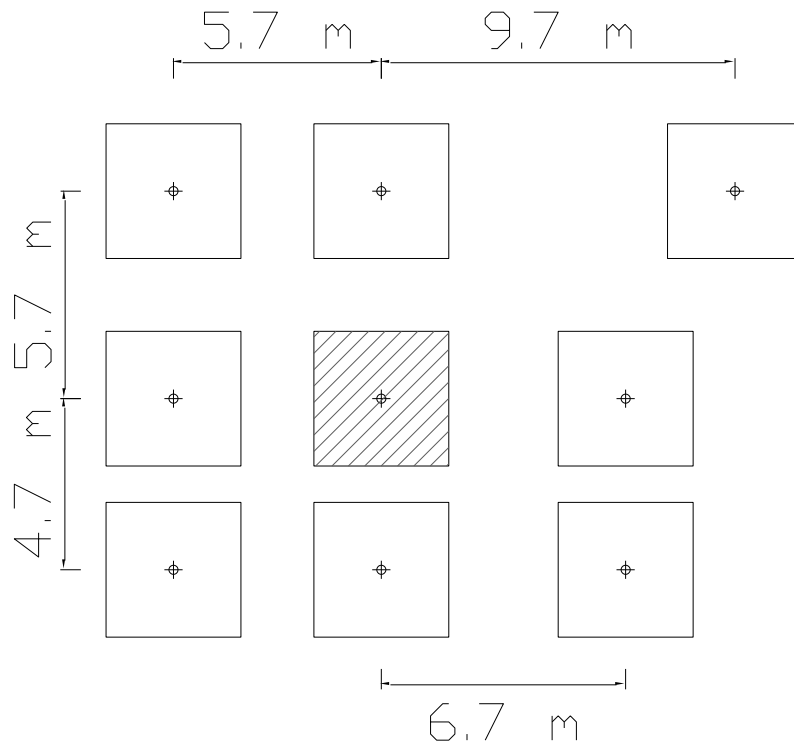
Pianta schematica dei pilastri della cava sotterranea (a tratteggio il pilastro da verificare).
